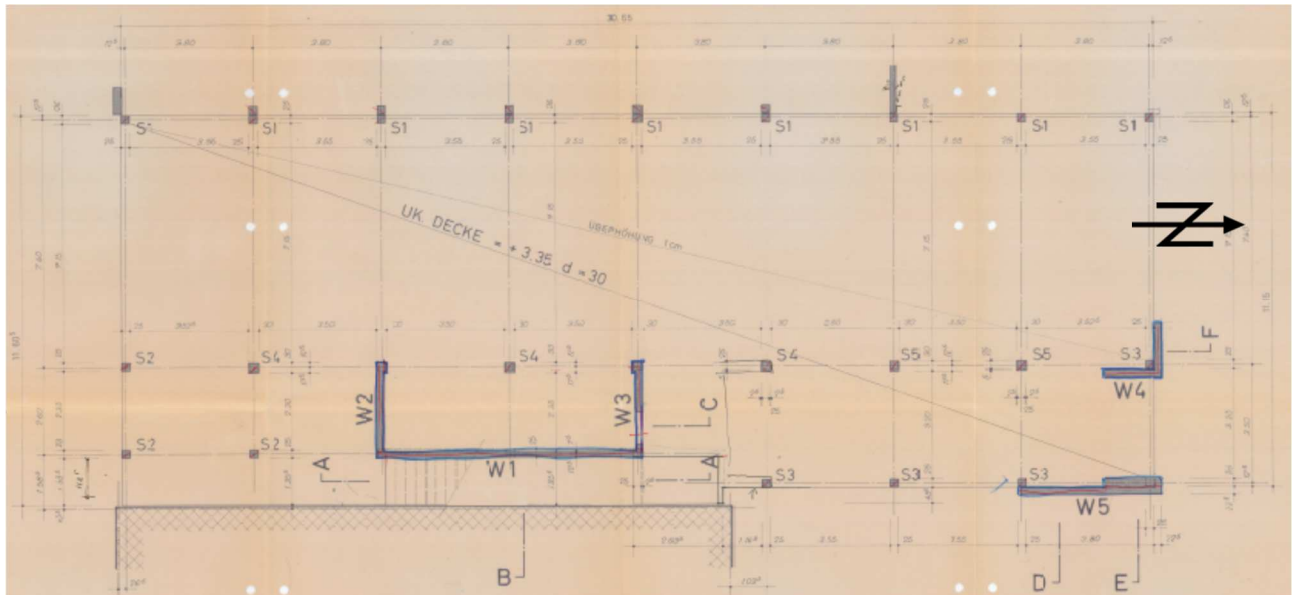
Grundriss Gebäudeteil 2, Schulgebäude Erdgeschoss.
